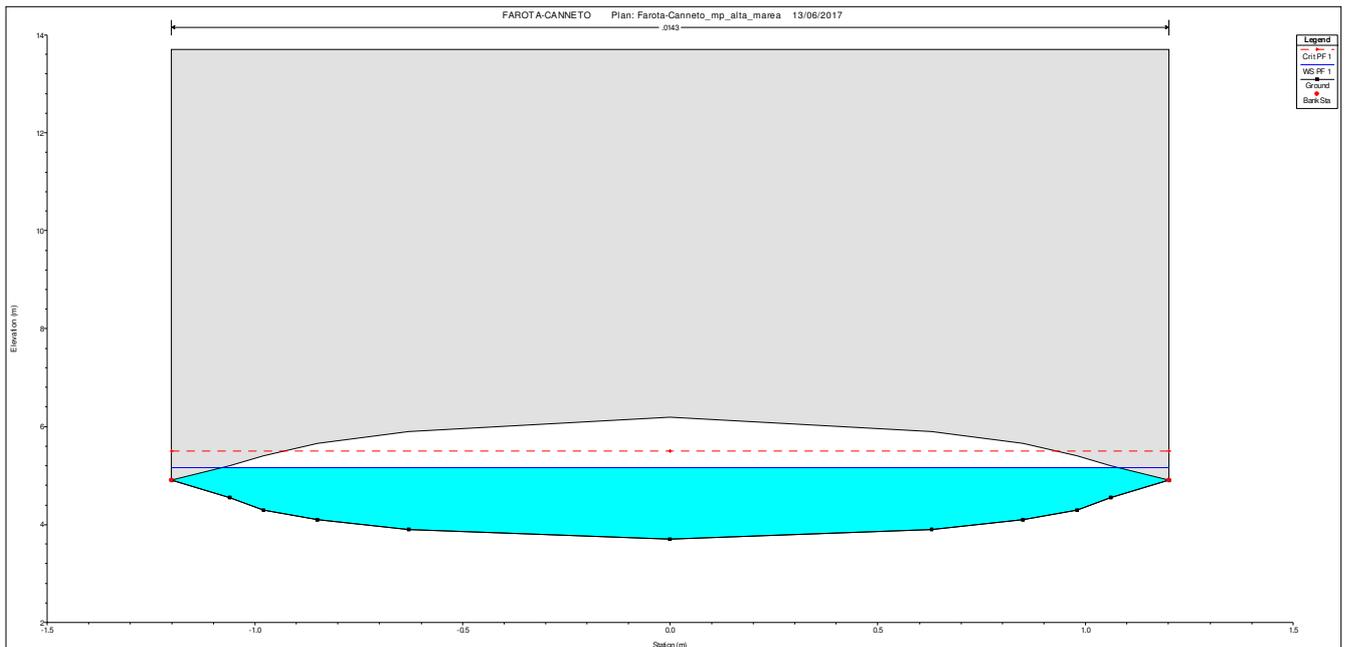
sezione idraulica di piena nel tubo spinto di attraversamento della linea ferroviaria
